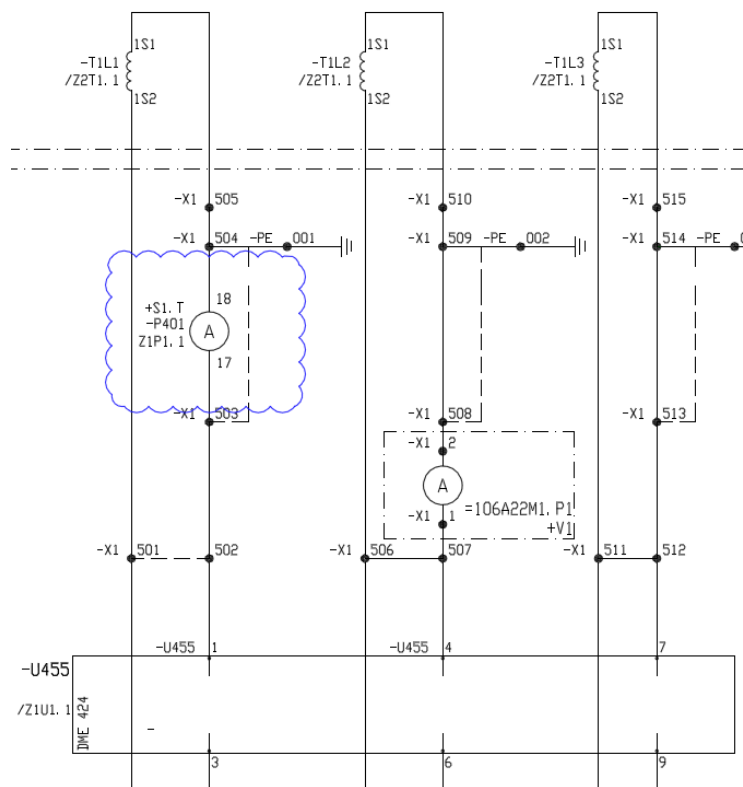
STROOMKRINGSCHEMA STROOMMETING
